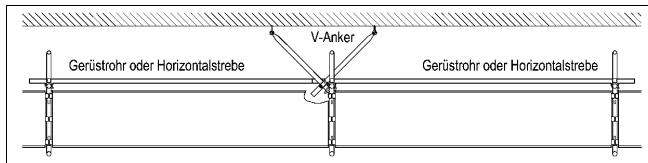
Horizontalstreben oder Gerüstrohre auf beiden Seiten des V-Ankers
